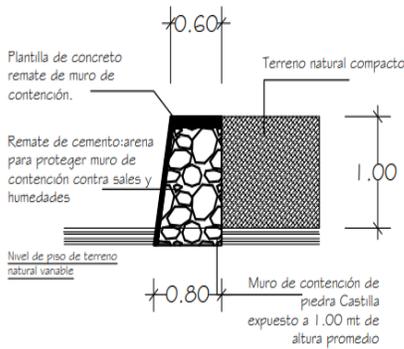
Detalles y Alzados de las obras presentes en el predio.
